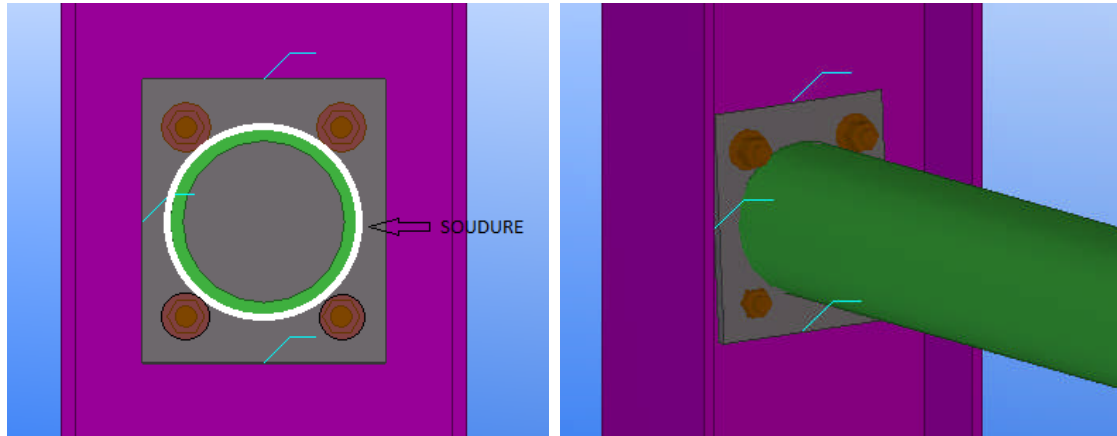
assemblage platine poutre par cordon de soudure.
